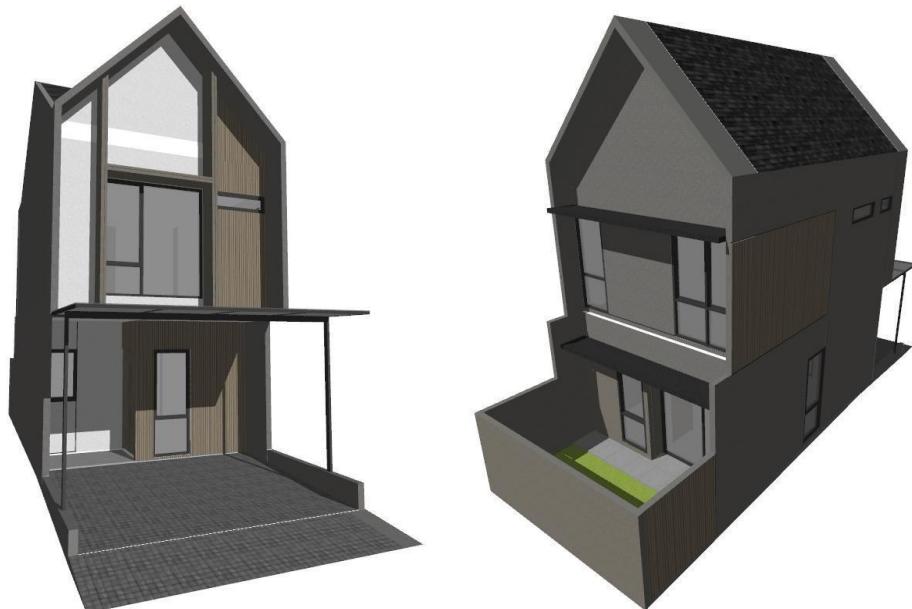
Potongan Tipe Bangunan 5x13 Standard
